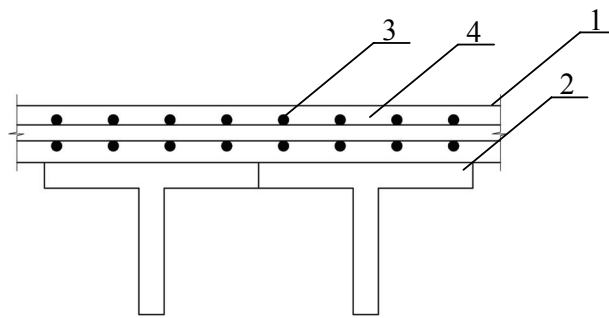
Накладная монолитная железобетонная плита: 1 – железобетонная накладная плита; 2 – железобетонная балка; 3 – стержни рабочей арматуры плиты; 4 – монтажная арматура.
